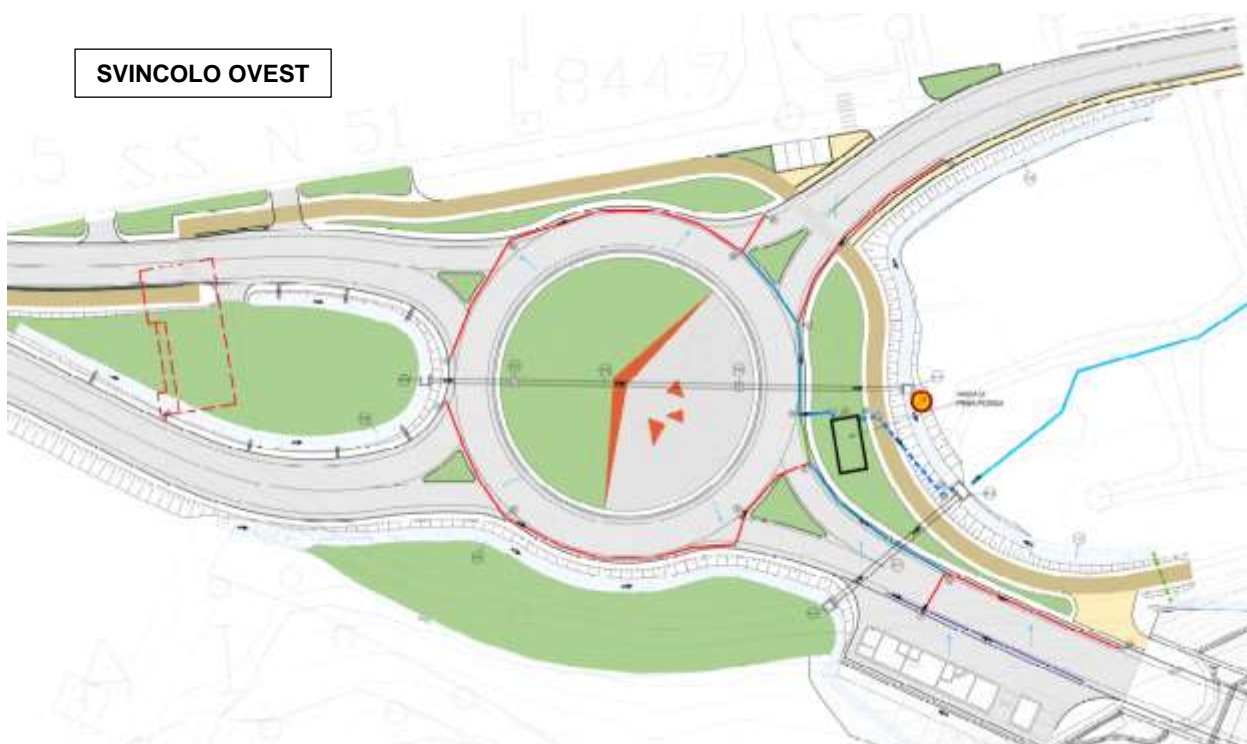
Stralcio planimetrico smaltimento acque meteoriche - imbocco Ovest
